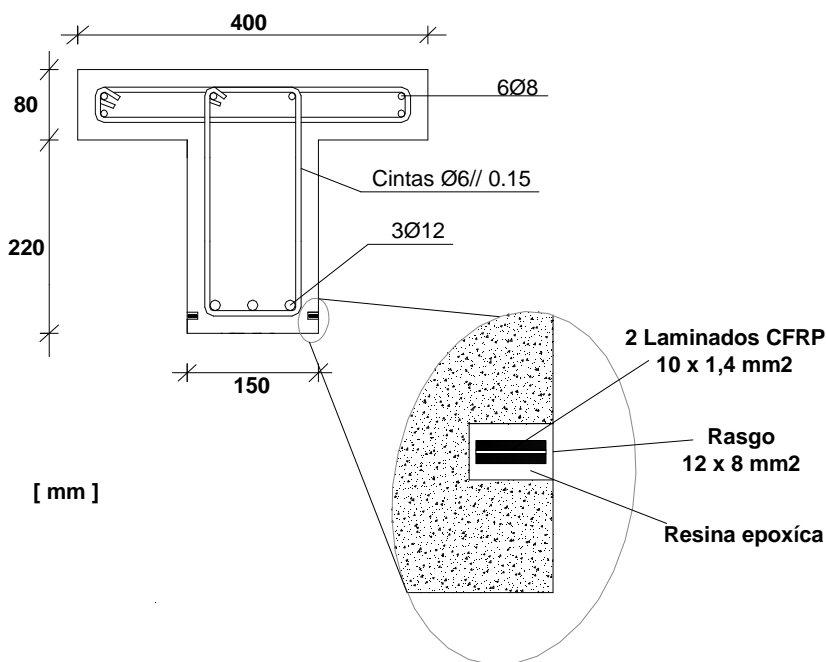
Secção transversal de meio-vão da viga reforçada com a técnica EBRA
